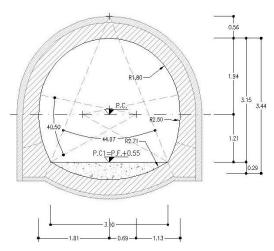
Sezione tipo di intradosso uscita di emergenza pedonale (sezione corrente)
